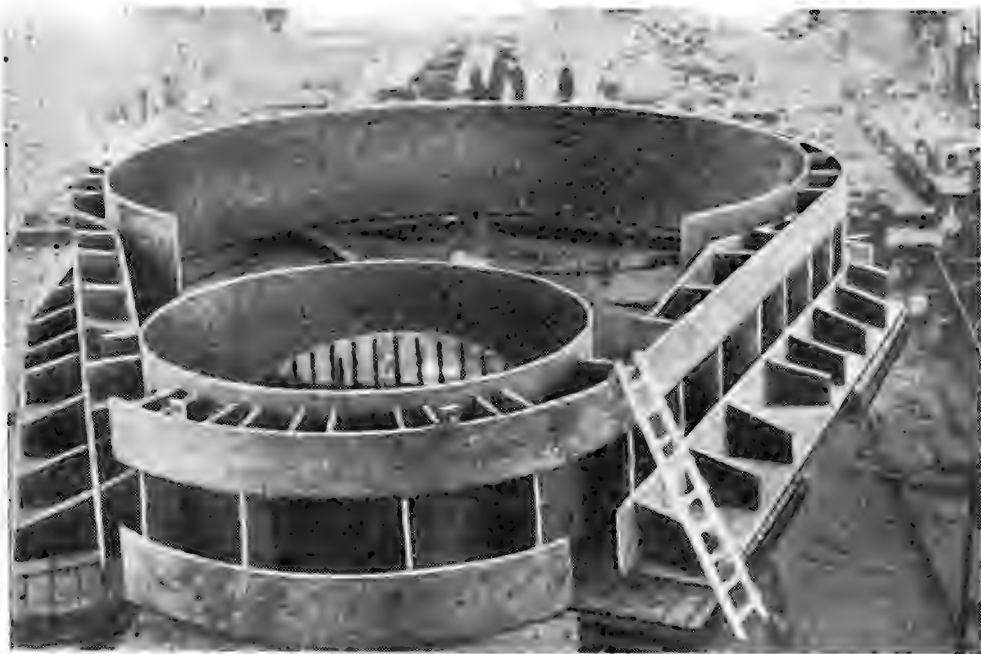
Купол воздухонагревателя с выносной камерой горения
